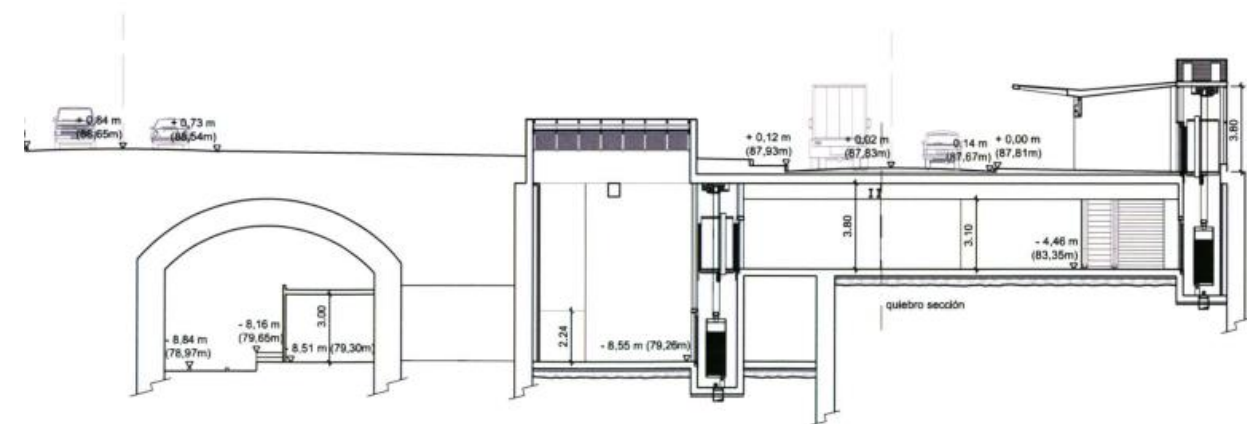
SECCIÓN ESTACIÓN ELCHE CARRÚS. PROYECTO AYESA
